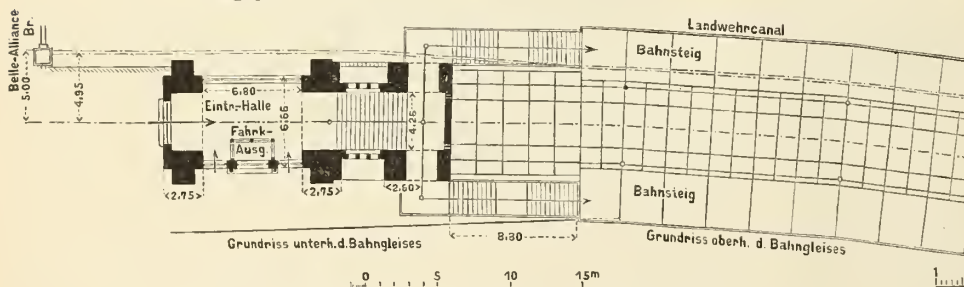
Grundriss. Haltestelle „Hallesches Thor“.
